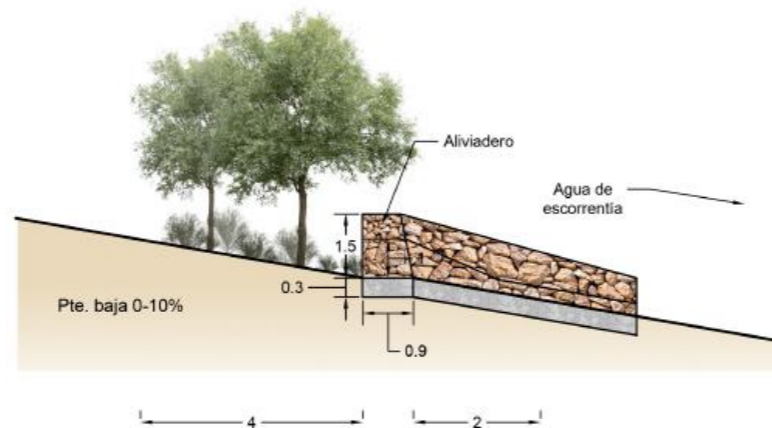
Sección de muro de piedra con aliviadero protegido propuesto.
